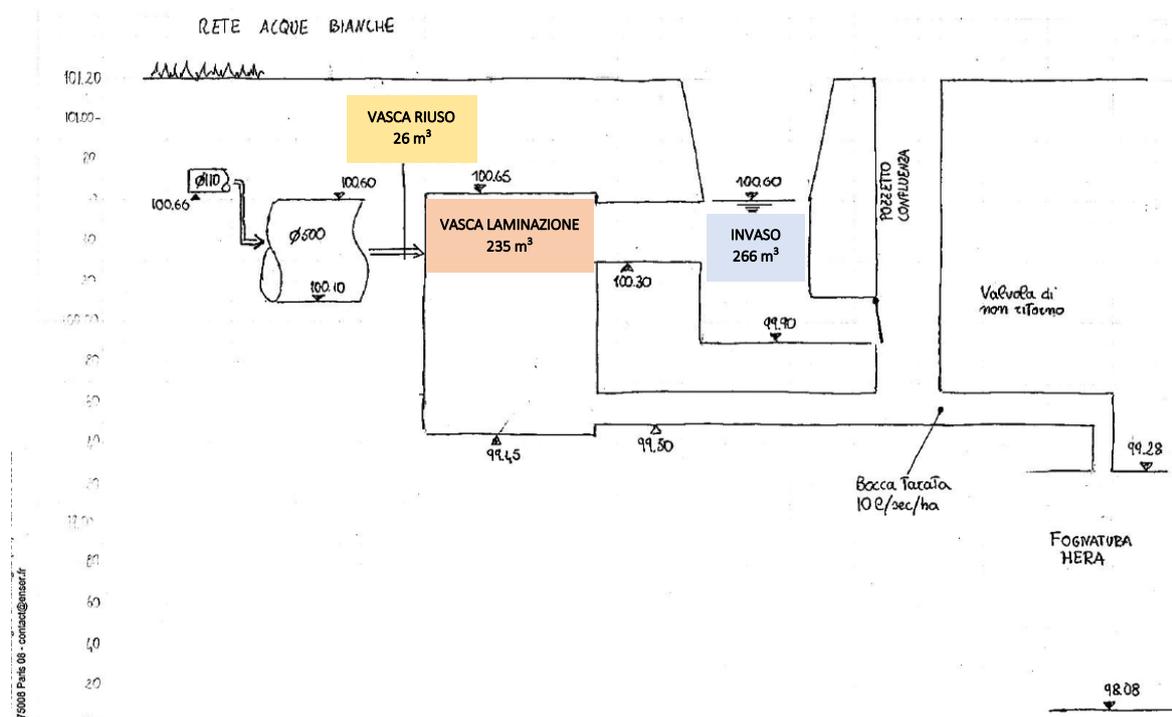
Schema del sistema di laminazione delle acque meteoriche.
